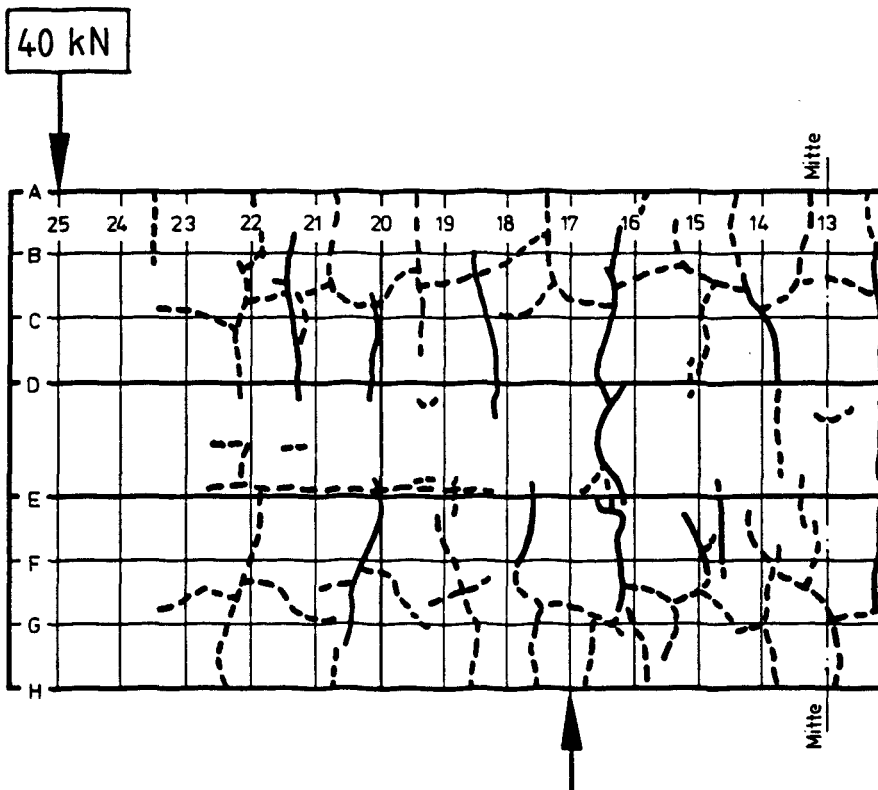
Rißbild unter Gebrauchslast, Ergänzung mit Spritzbeton
